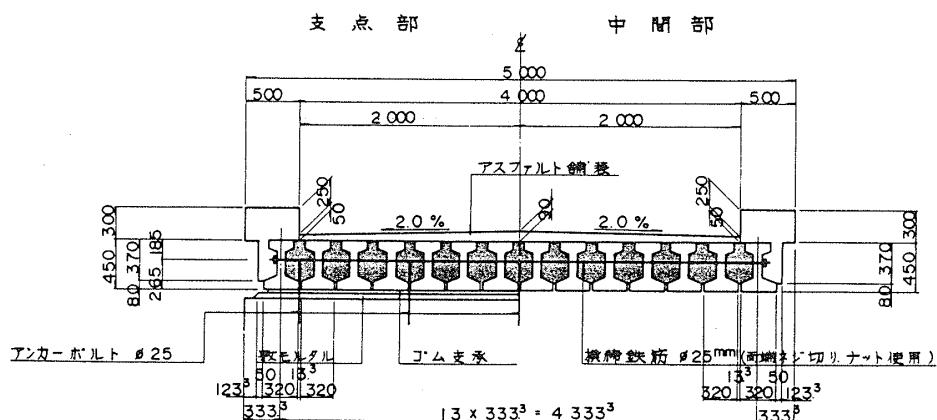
軽荷重スラブ橋用PC橋げた設計例²⁰⁾
